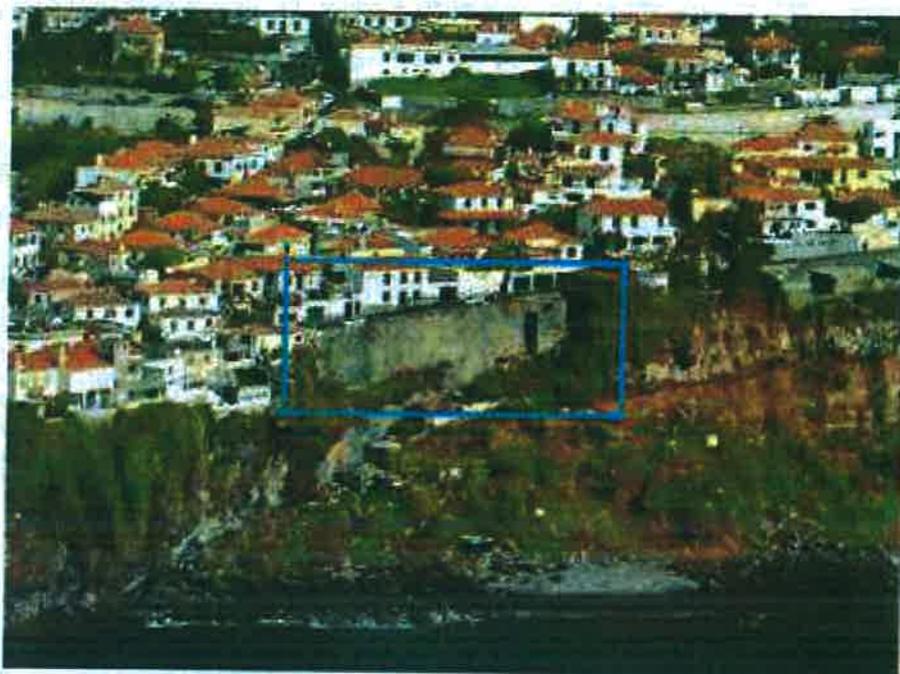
Vista geral do muro de suporte na rua do Lazareto
